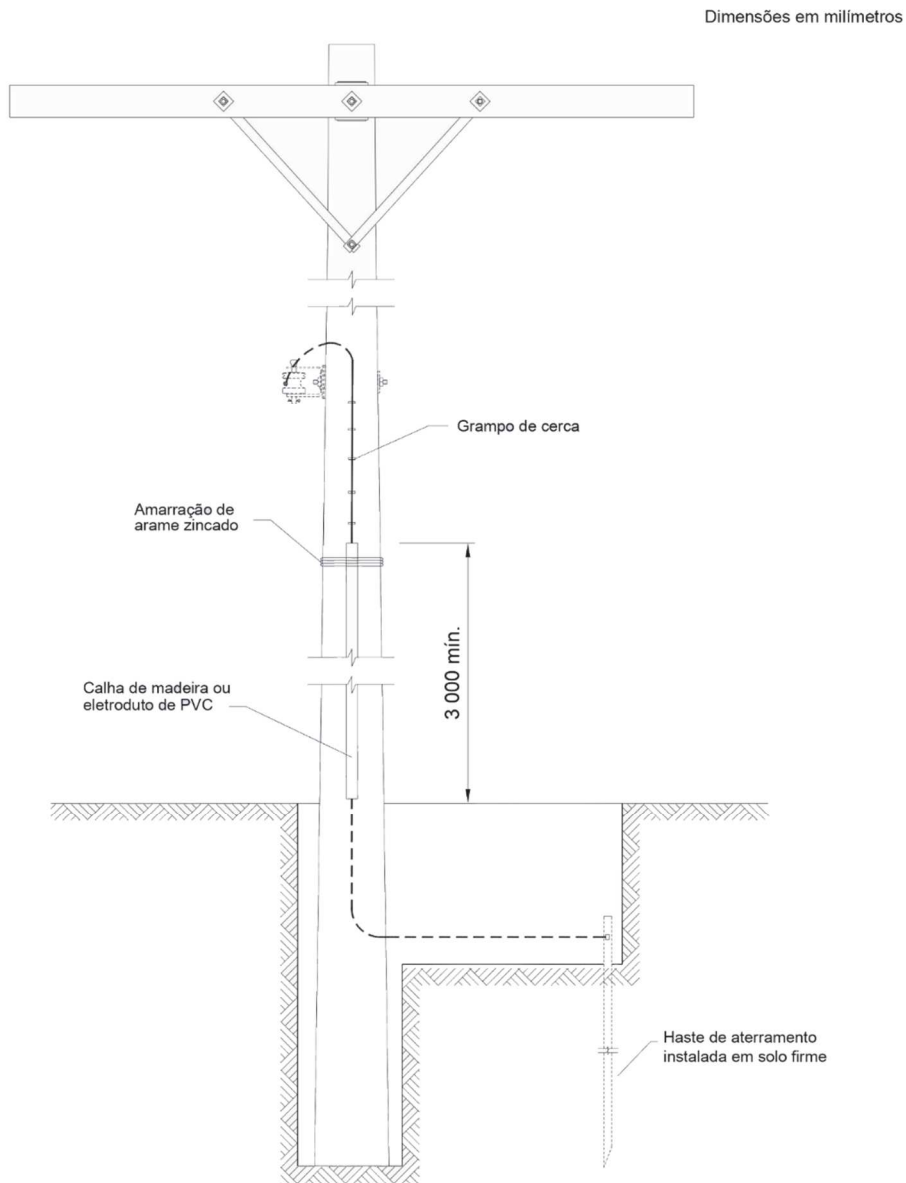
Amarrações e ligações – Amarração e ligação à terra – Poste de madeira
